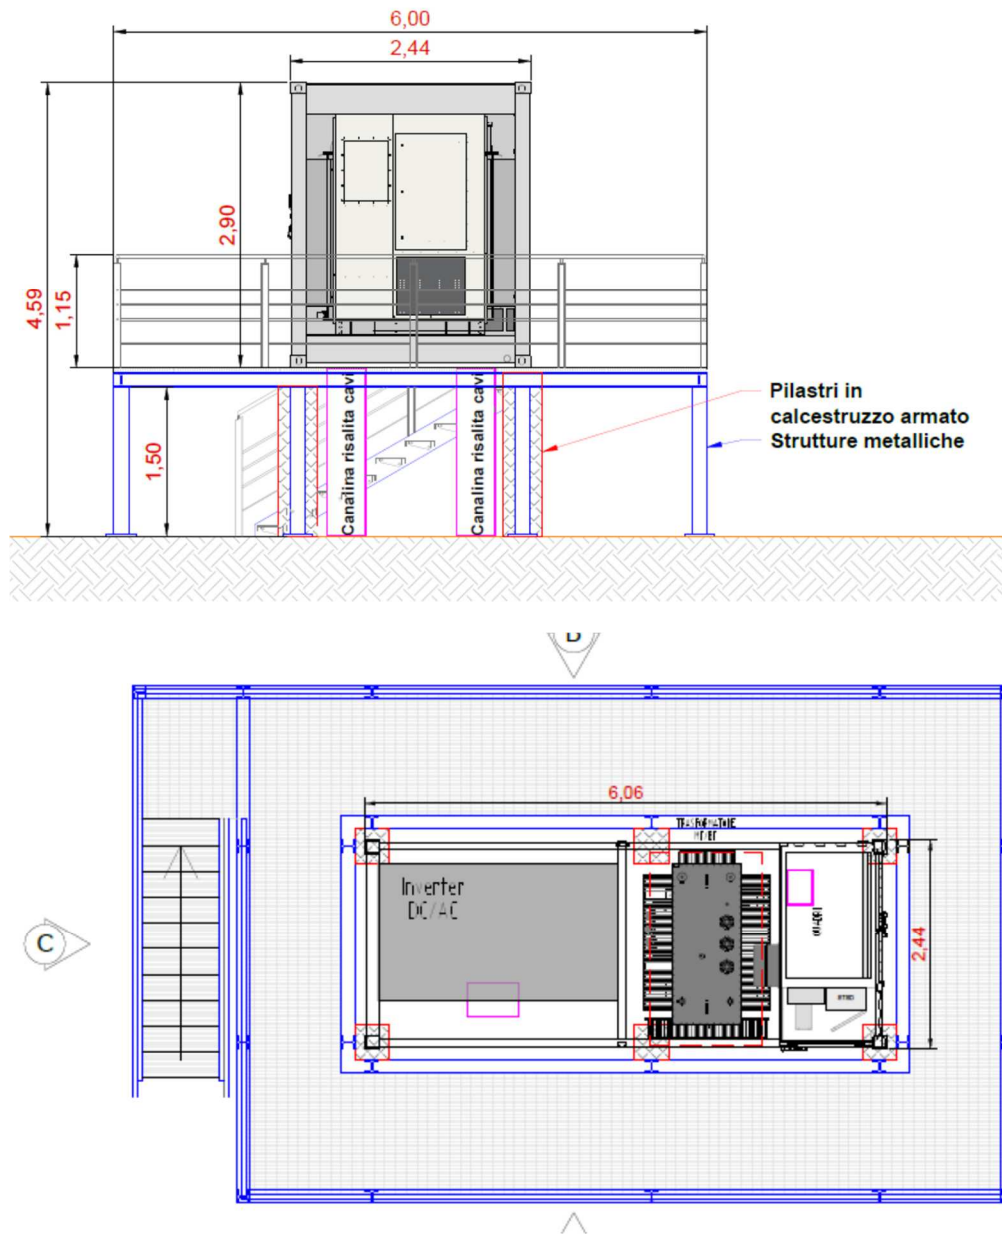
Vista planimetrica delle strutture portanti di elevazione
